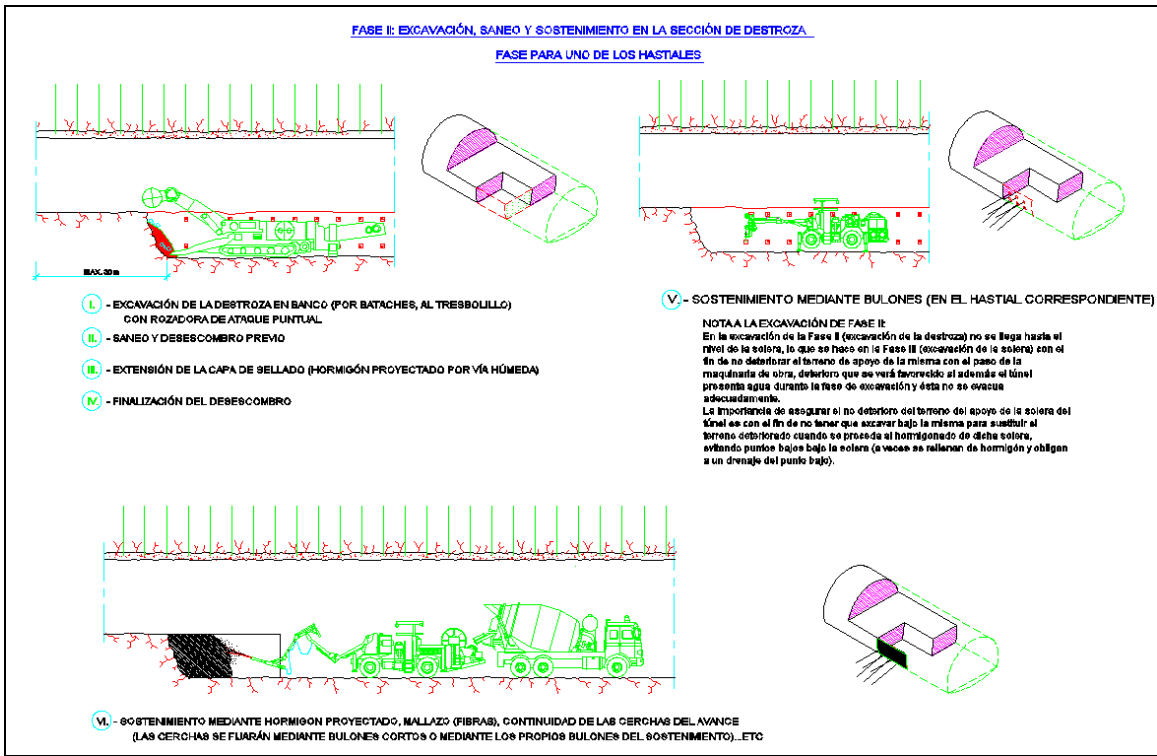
Fase de excavación en la sección de Destroza, primer hastial.
